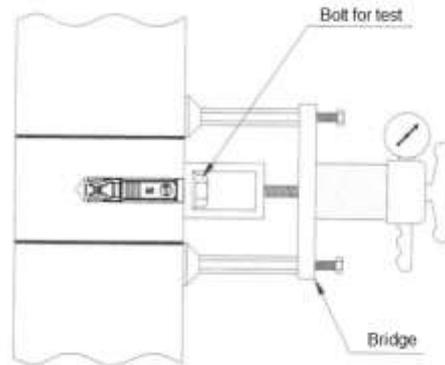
Exemple de banc d'essai pour vérifier une ancre dans un mur
